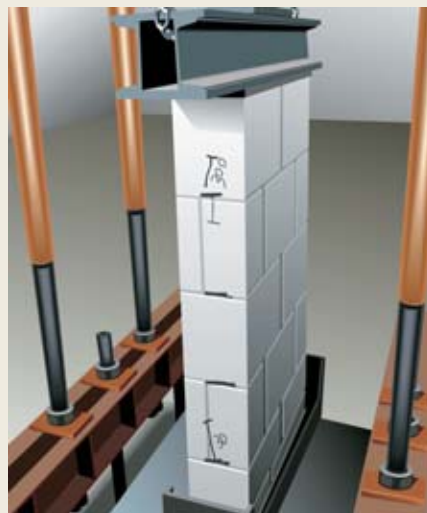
Aparecimento de fissuras nas paredes transversais
